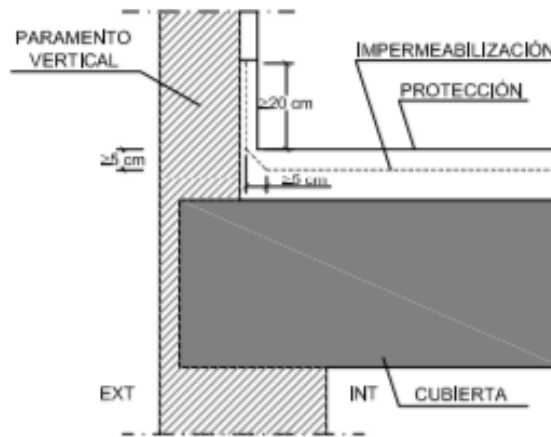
Encuentro de la capa impermeabilizante con el peto de la cubierta
